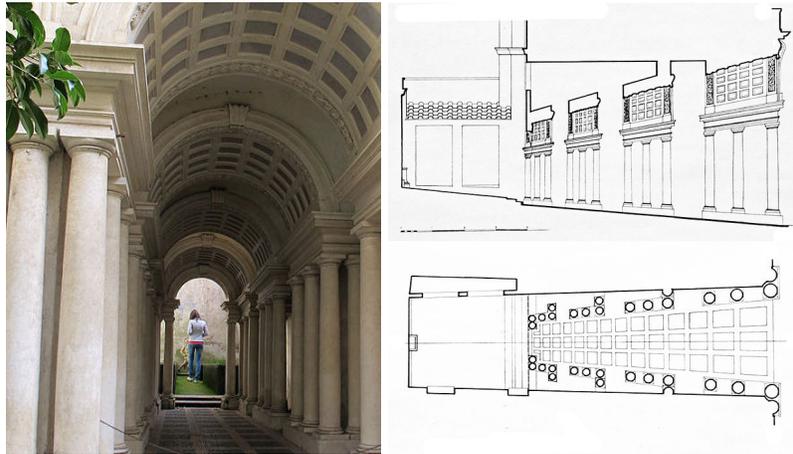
Portico prospettico di Palazzo Spada. È la statua a essere piccola, non la persona gigantesca. A destra: spaccato e pianta del portico.
